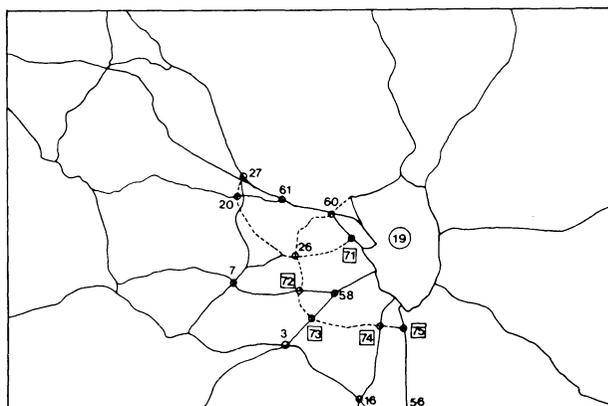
Trazado del Plan Estratégico de la Zona Oeste.
